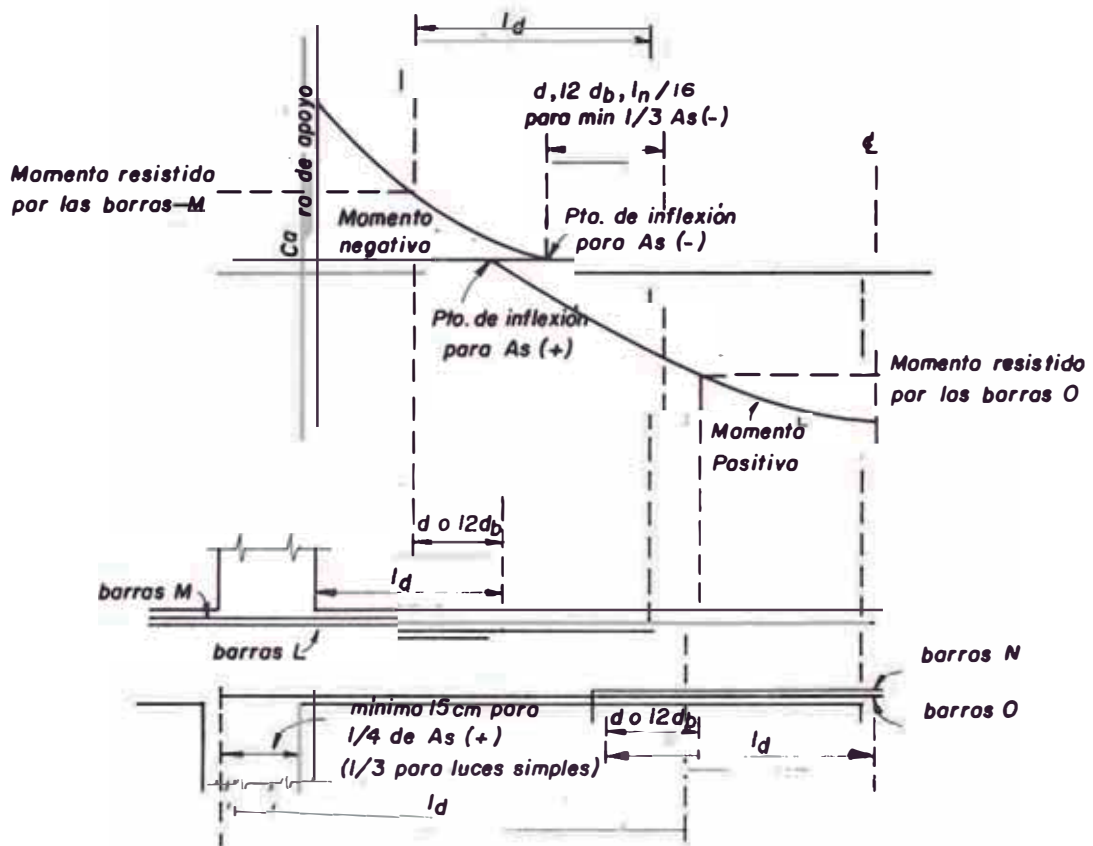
Longitud de desarrollo y detalles de corte para acero de refuerzo sujeto a flexión en vigas típicas
